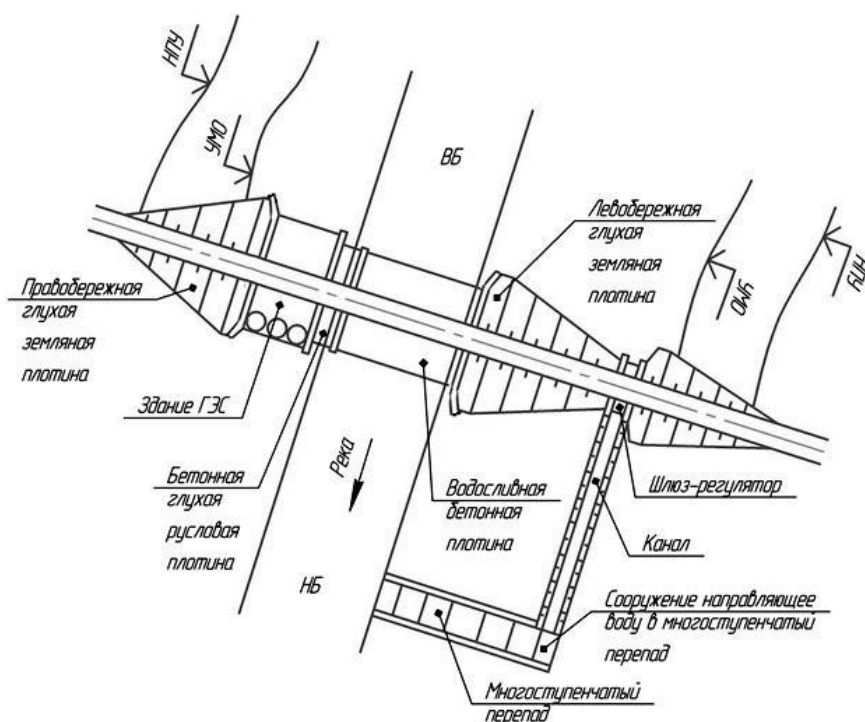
Схема гидроузла в составе береговых грунтовых плотин, сопряженных с русловой компоновкой поверхностного водосброса и здания ГЭС
